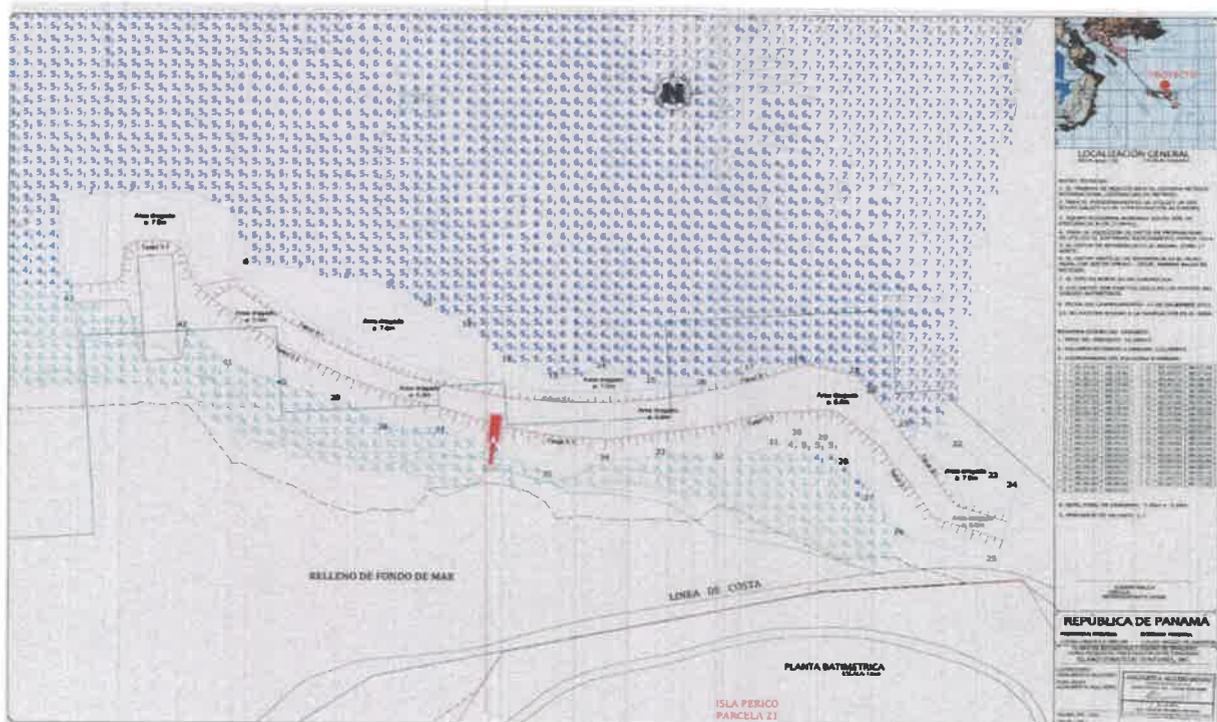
Plano de Batimetría y Diseño de Dragado. Tomado de la Primera Aclaratoria (Anexo 1)
